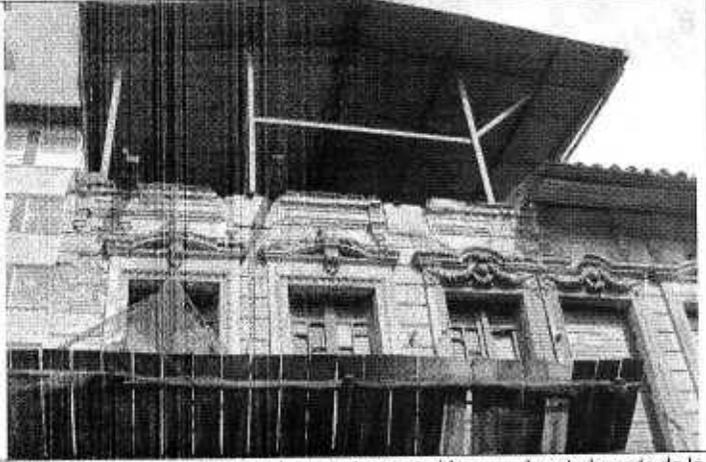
Vista de la cubierta suplementaria construida para el costado norte de la edificación emplazada en el predio de la Carrera 7 No. 6-22 / 26.
